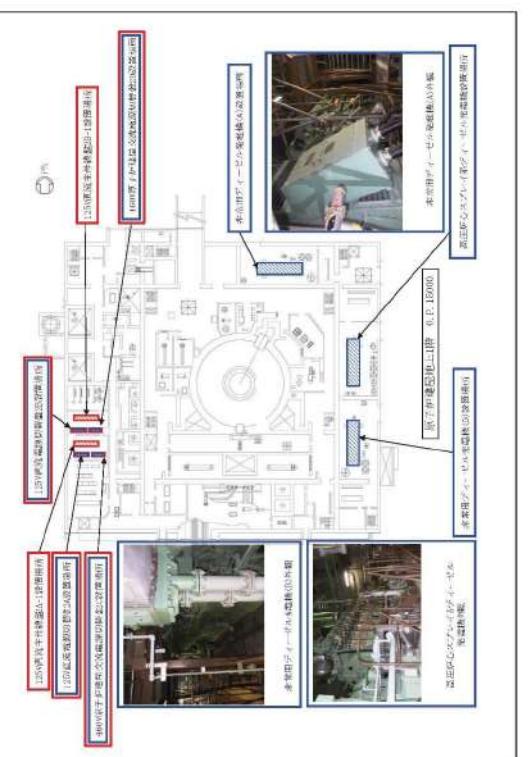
配置図（原子炉建屋 地上 1 階）
